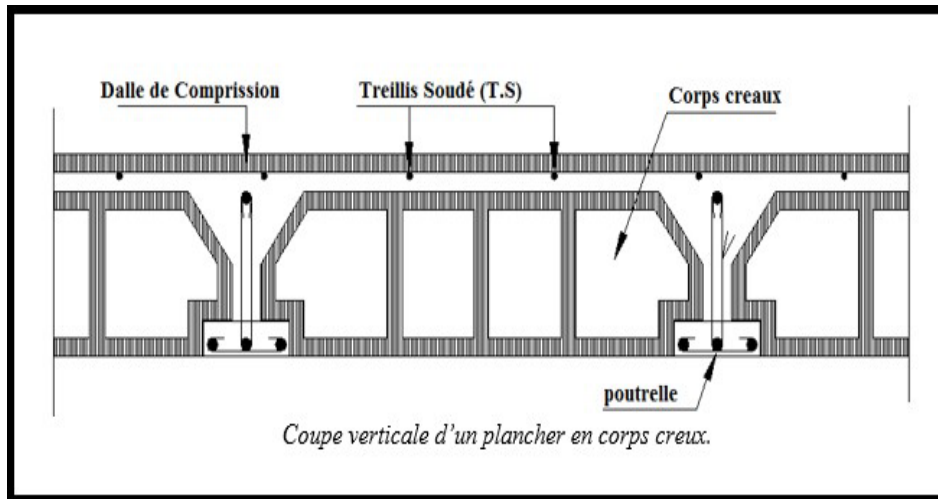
coupe verticale d'un plancher en corps creux
